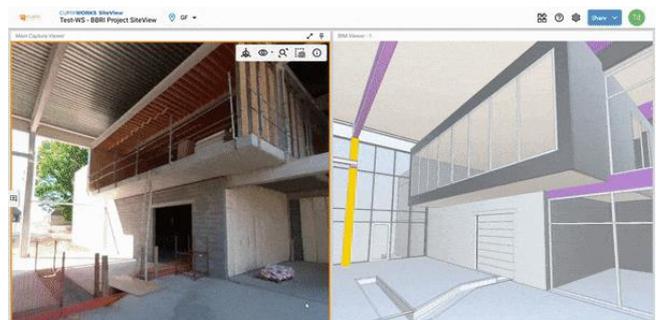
Suivi de chantier et états d'avancement facilités par le BIM
